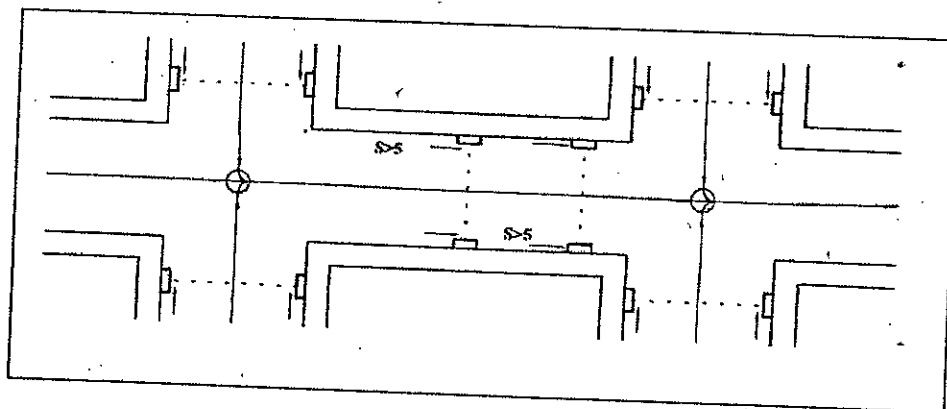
Ubicación de Coladeras Longitudinales de Banqueta.
